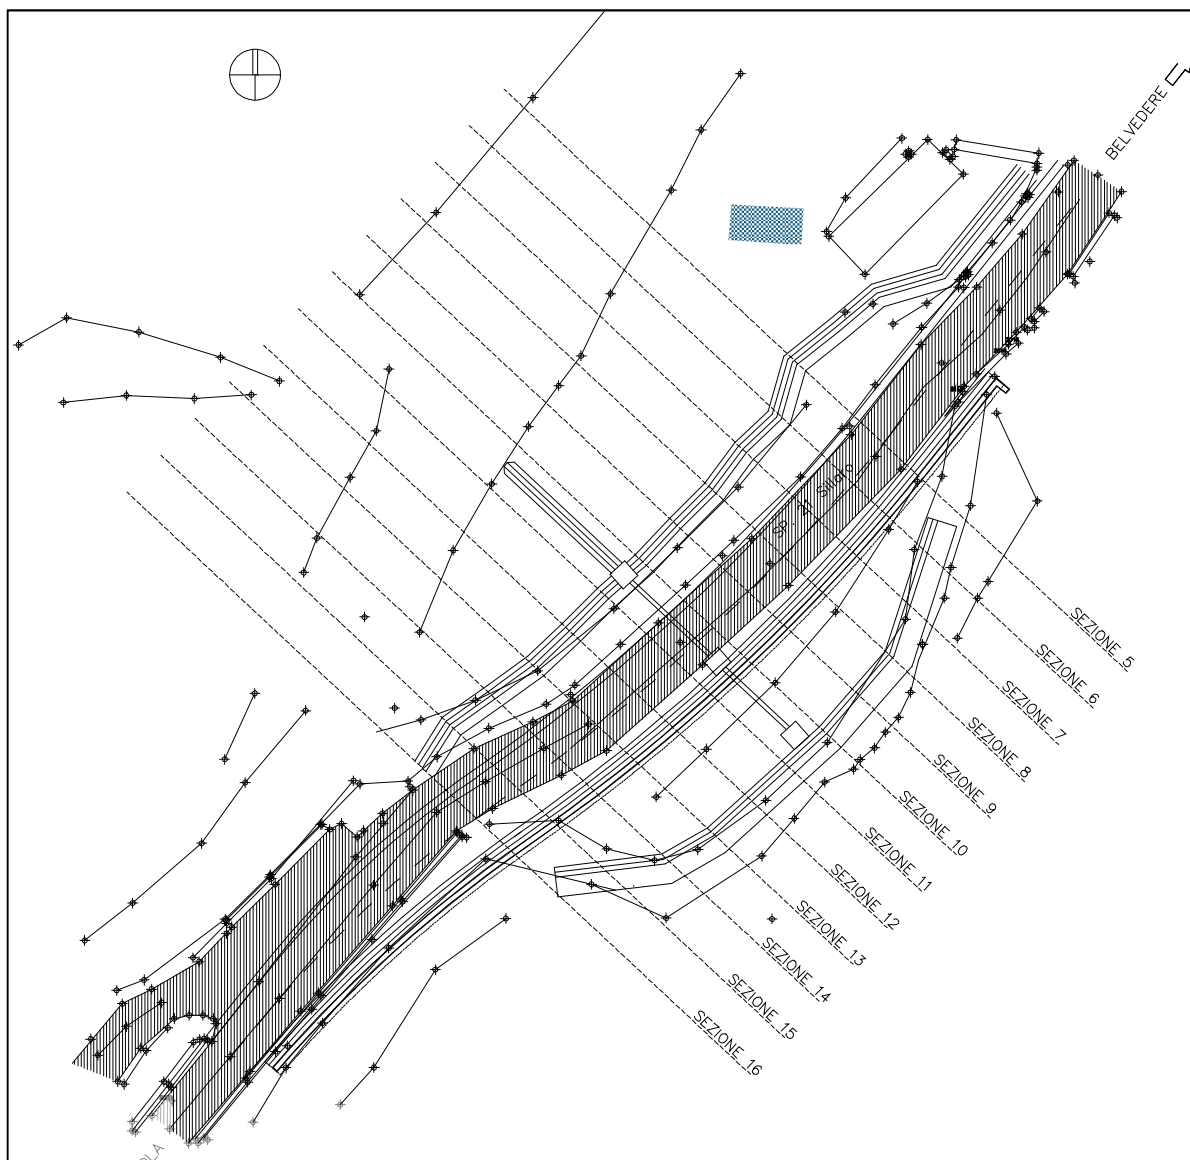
Planimetria area di intervento alla progressiva km 33+00
